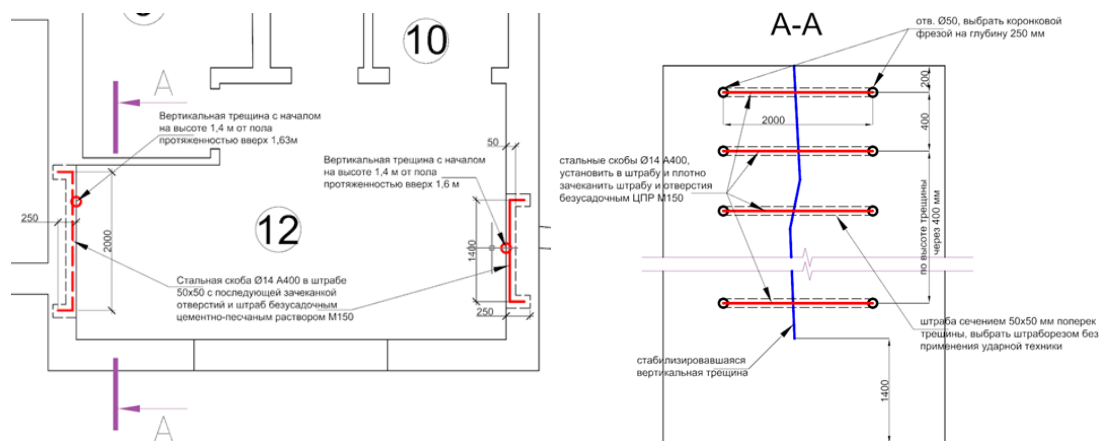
Рекомендованная схема усиления стен с трещинами установкой стальных скоб
